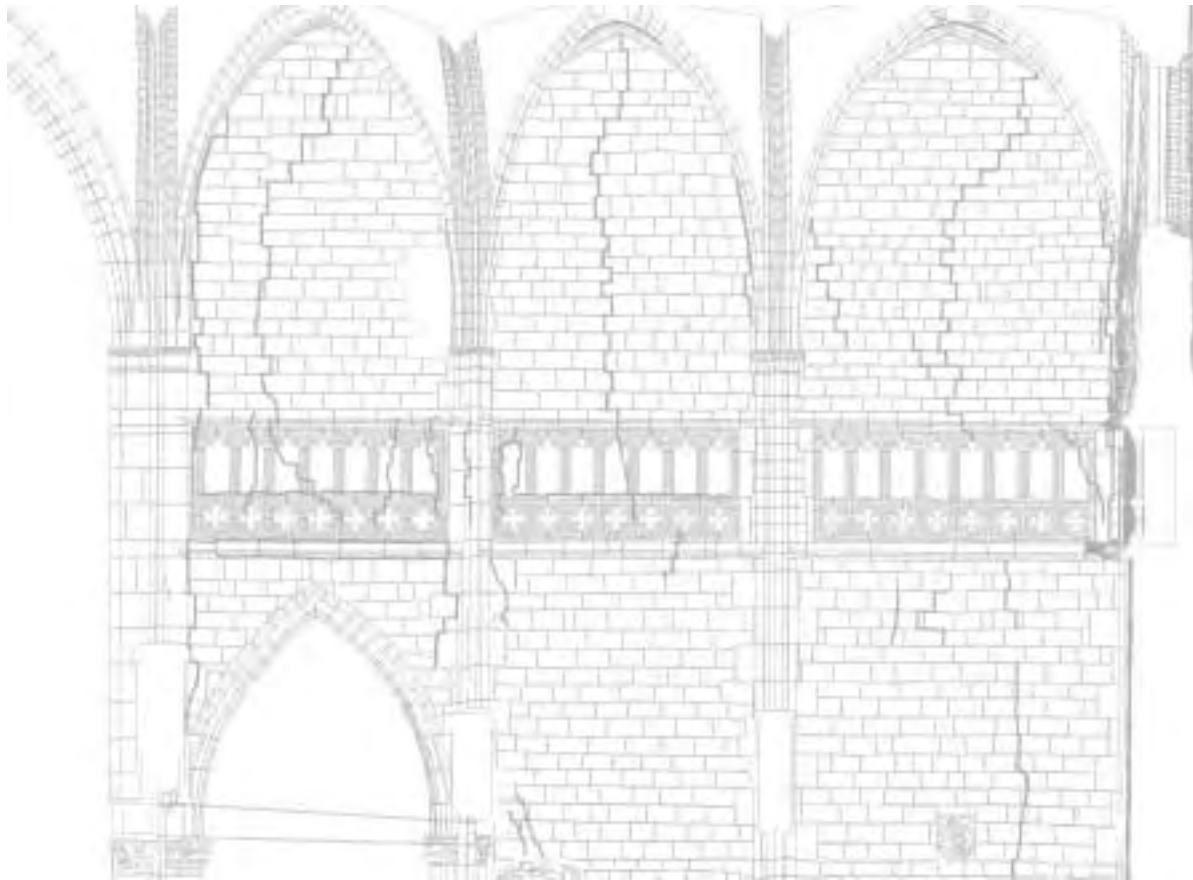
Sección del transepto hacia el oeste. Fisuras
